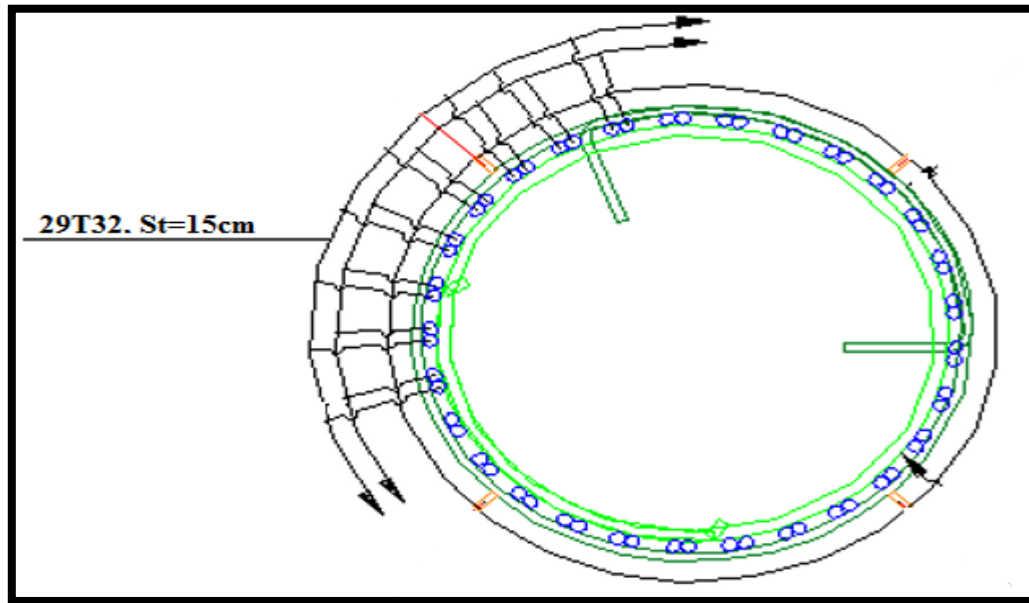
Schéma de ferrailage longitudinal (P7)
